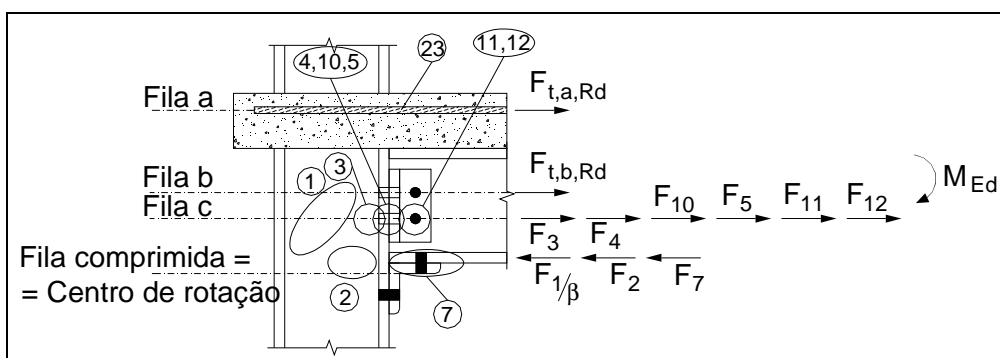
Ligação mista com cantoneiras de alma e assento com todas as filas traccionadas.
